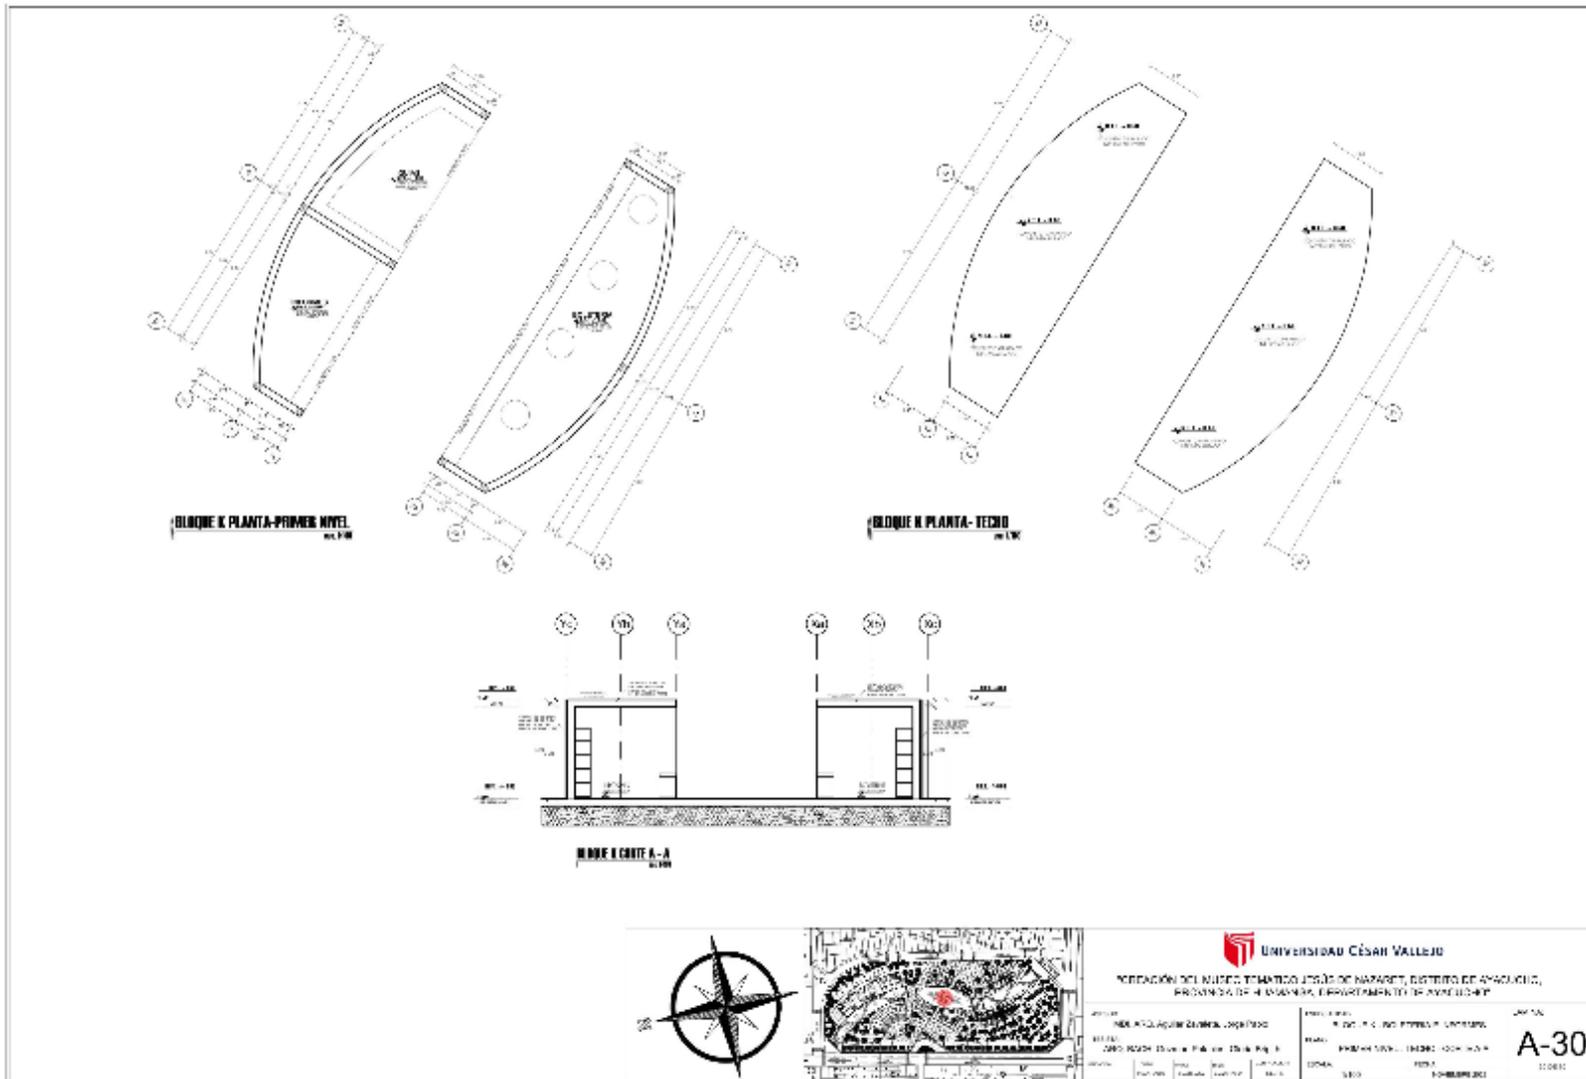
Bloque K – Plantas, cortes y elevaciones.
